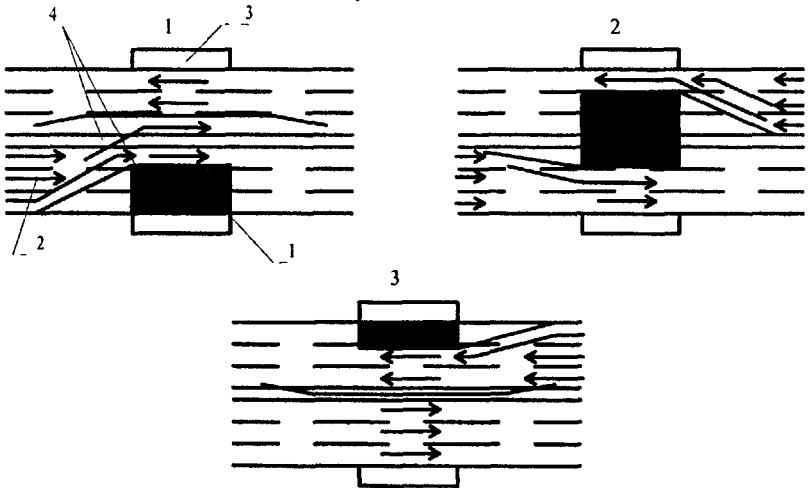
Последовательное перемещение строительной площадки при ремонте путепровода:
